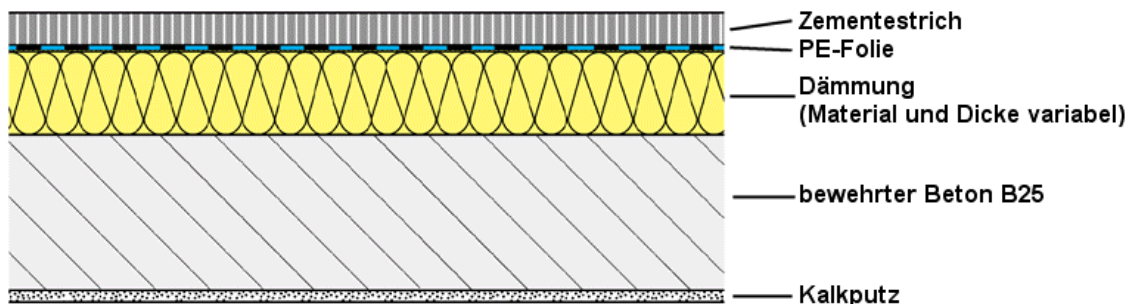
Grundaufbau der Beton-Geschossdecken
